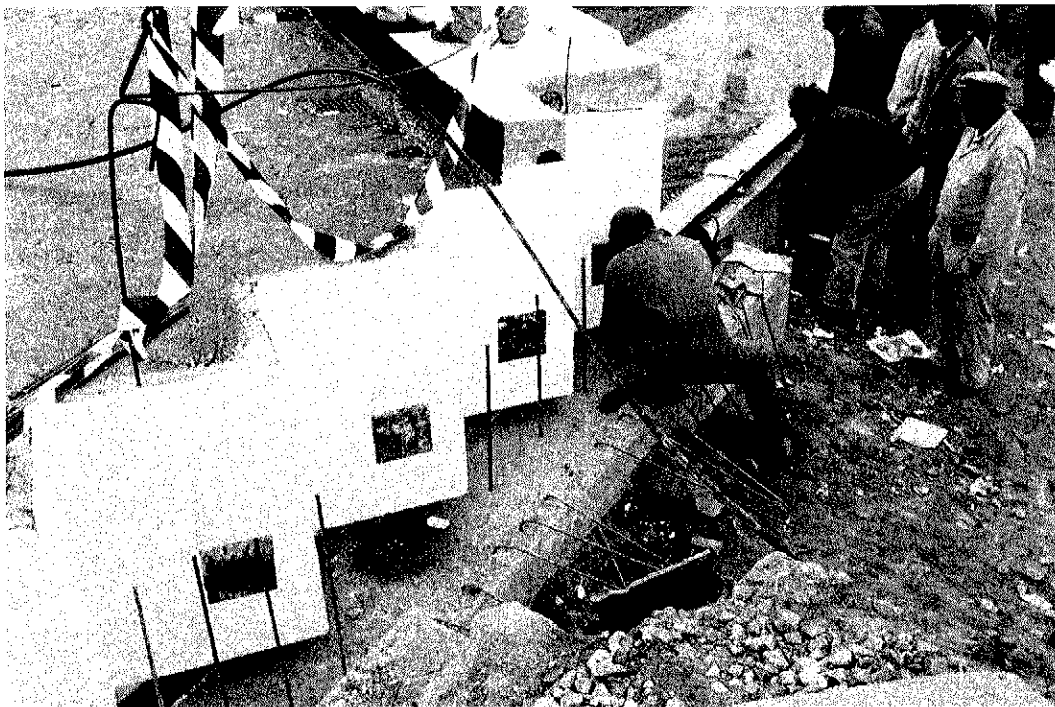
Detalle del extremo del tablero tras el ripado. Puede observarse, en el extremo de cada viga, el correspondiente tope de neopreno para la coacción horizontal del estribo.
